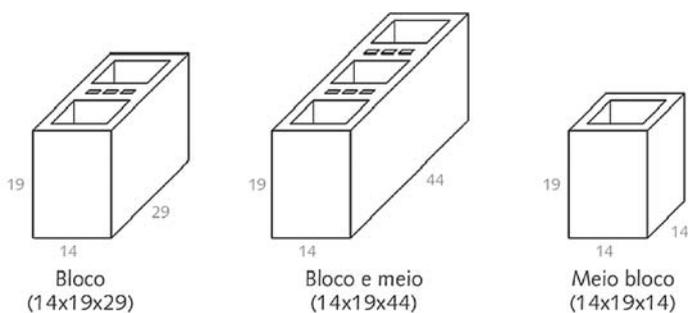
Bloco cerâmico utilizado nas propostas de tipologias
